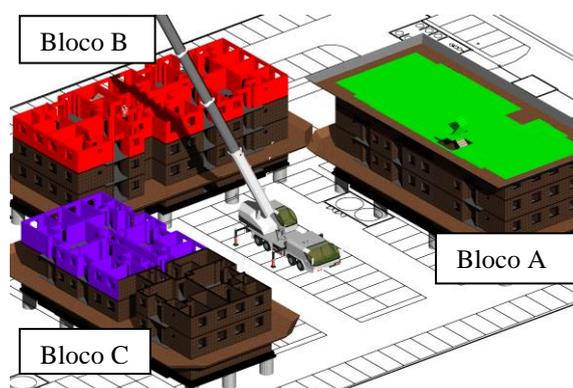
Lote dos Blocos A e B = pavimento (verde e vermelho); Lote do Bloco C = meio pavimento (roxo).
